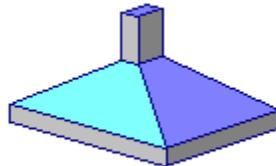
Zapata Aislada, Concreto, Cuadrada, Sección Variable, Interna
